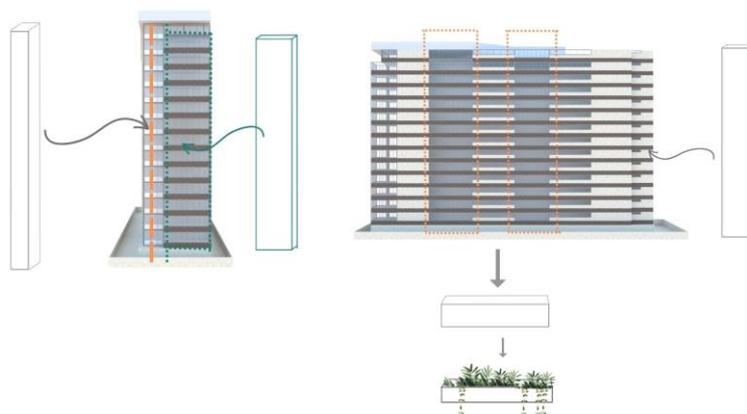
Edifício Renato B. de Melo - subtrações em cinza e adições em azul nas fachadas. Fonte: Adrião, 2024.
